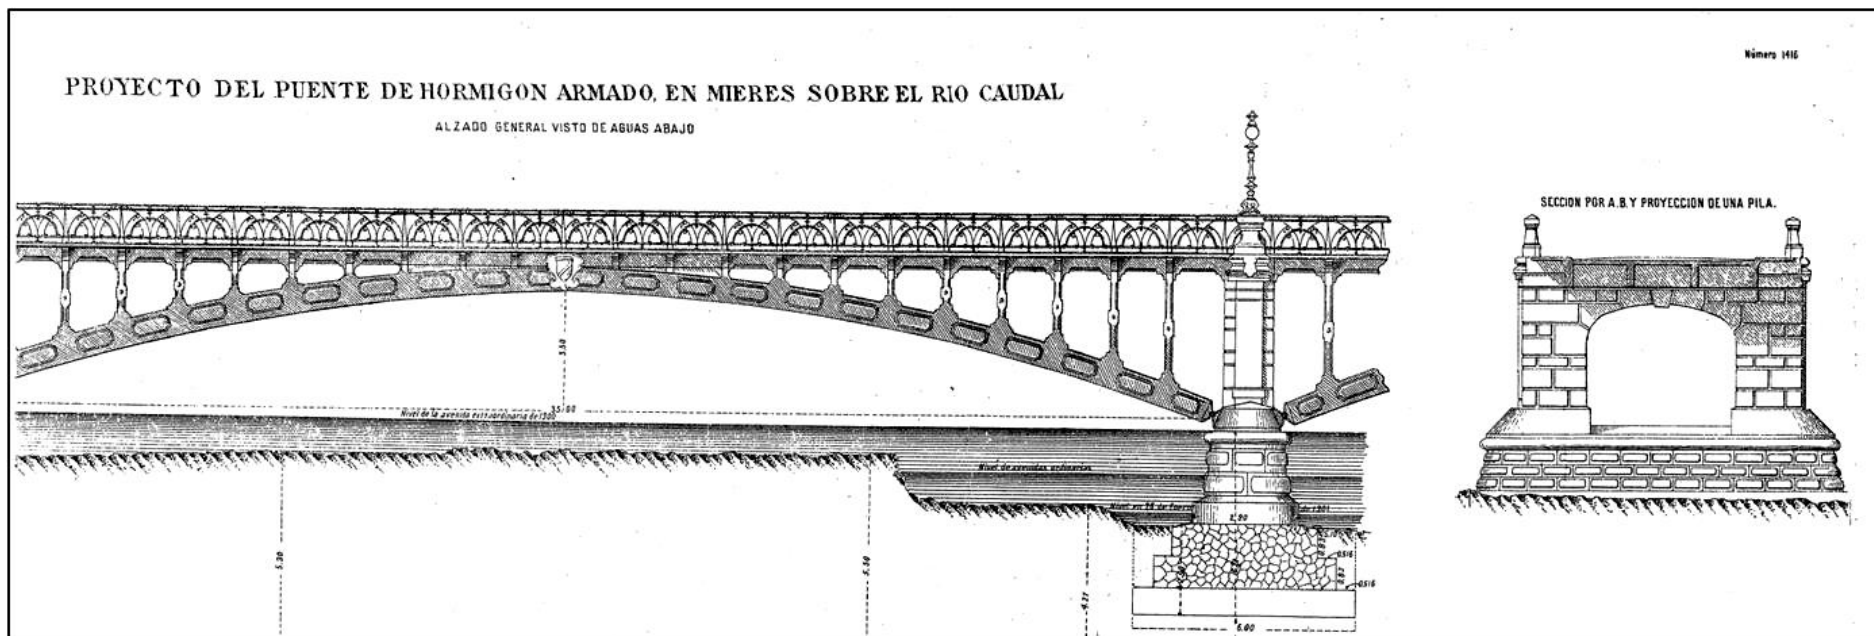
Proyecto de puente de hormigón armado en Mieres, sobre el río Caudal. Revista de Obras Públicas No. 81 1902
